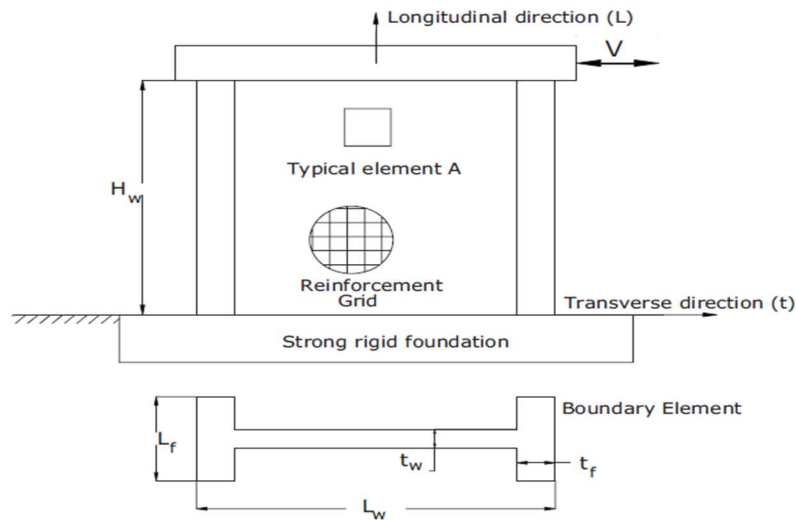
Esquema de un muro sometido a una carga lateral.
